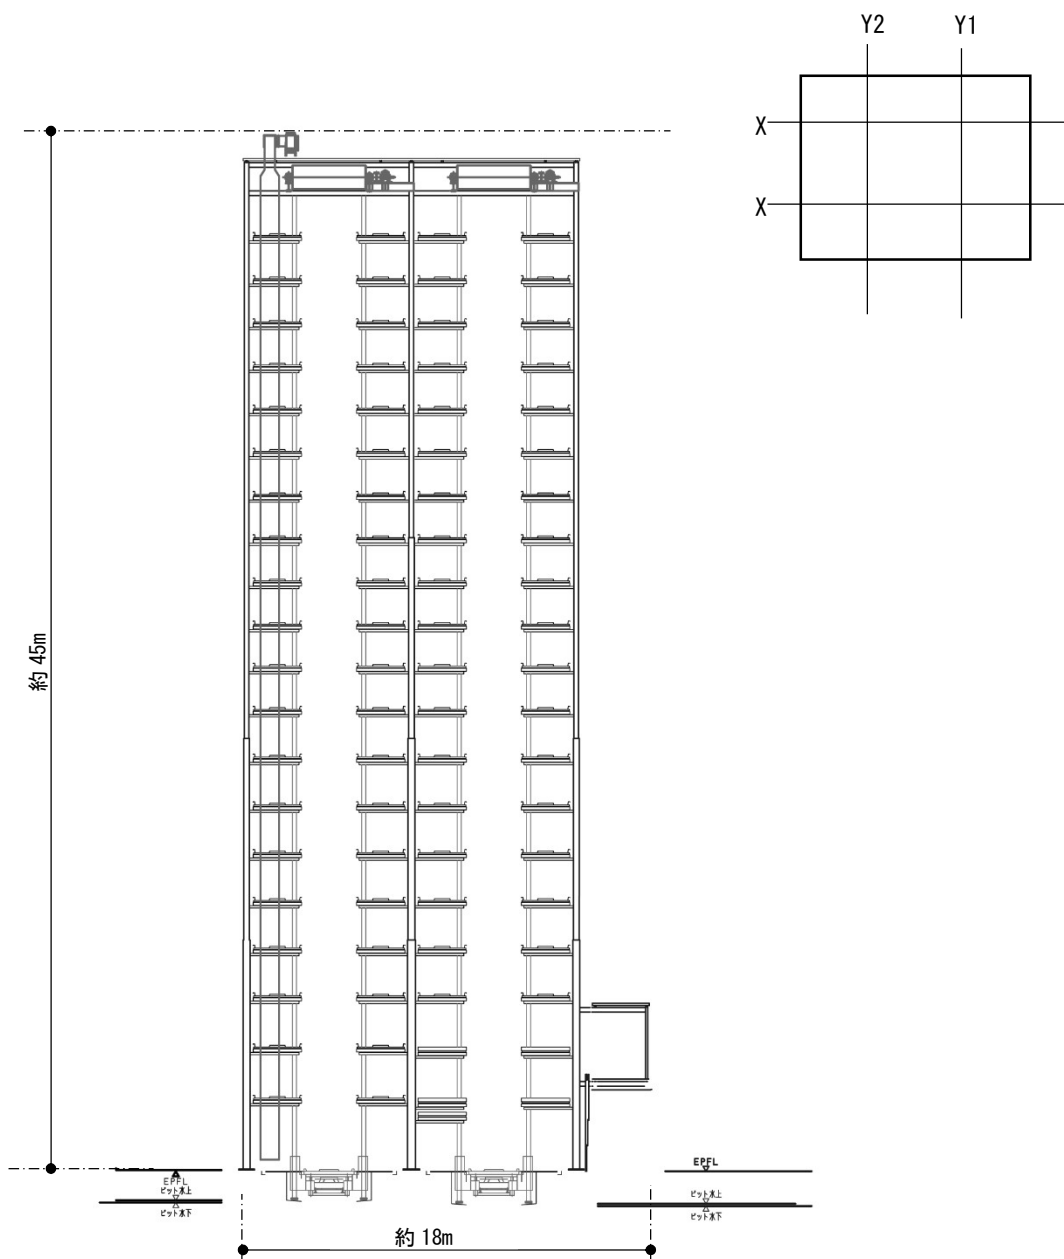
(2) タワーパーキング断面図 (X 断面)
